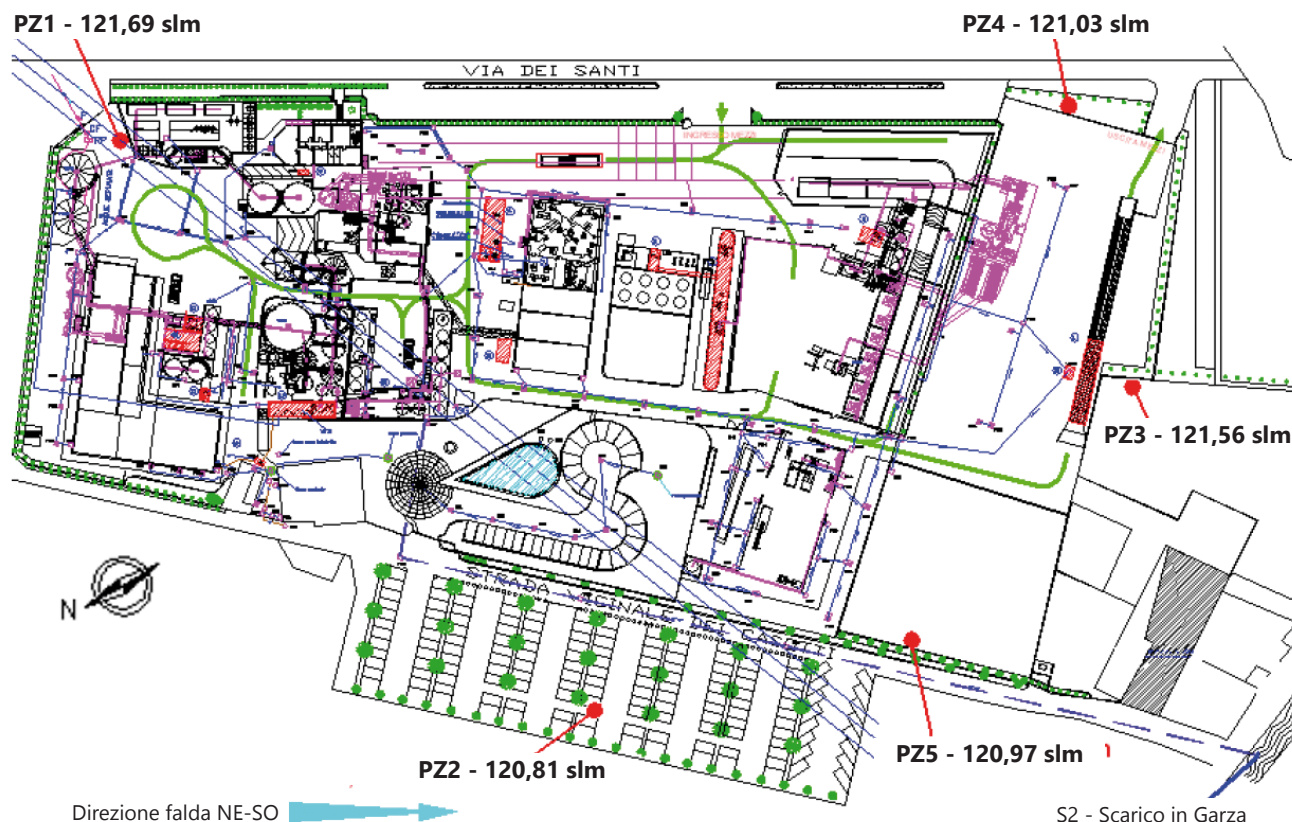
Planimetria della piattaforma con l'ubicazione dei piezometri
